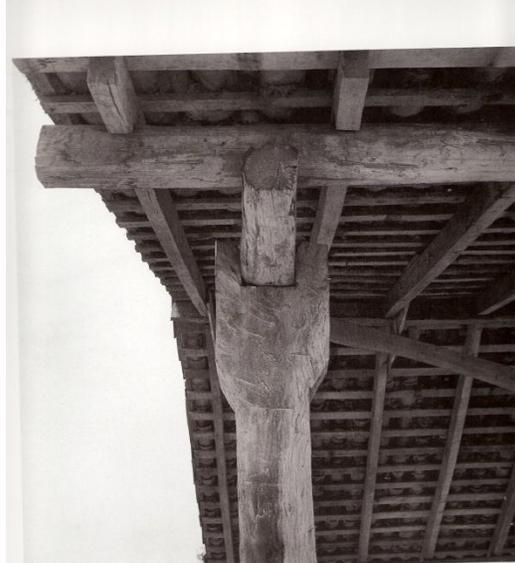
Estructura de madera desarmable y transportable. Foto Mariana Yampolsky, La Casa que Canta (1982)
